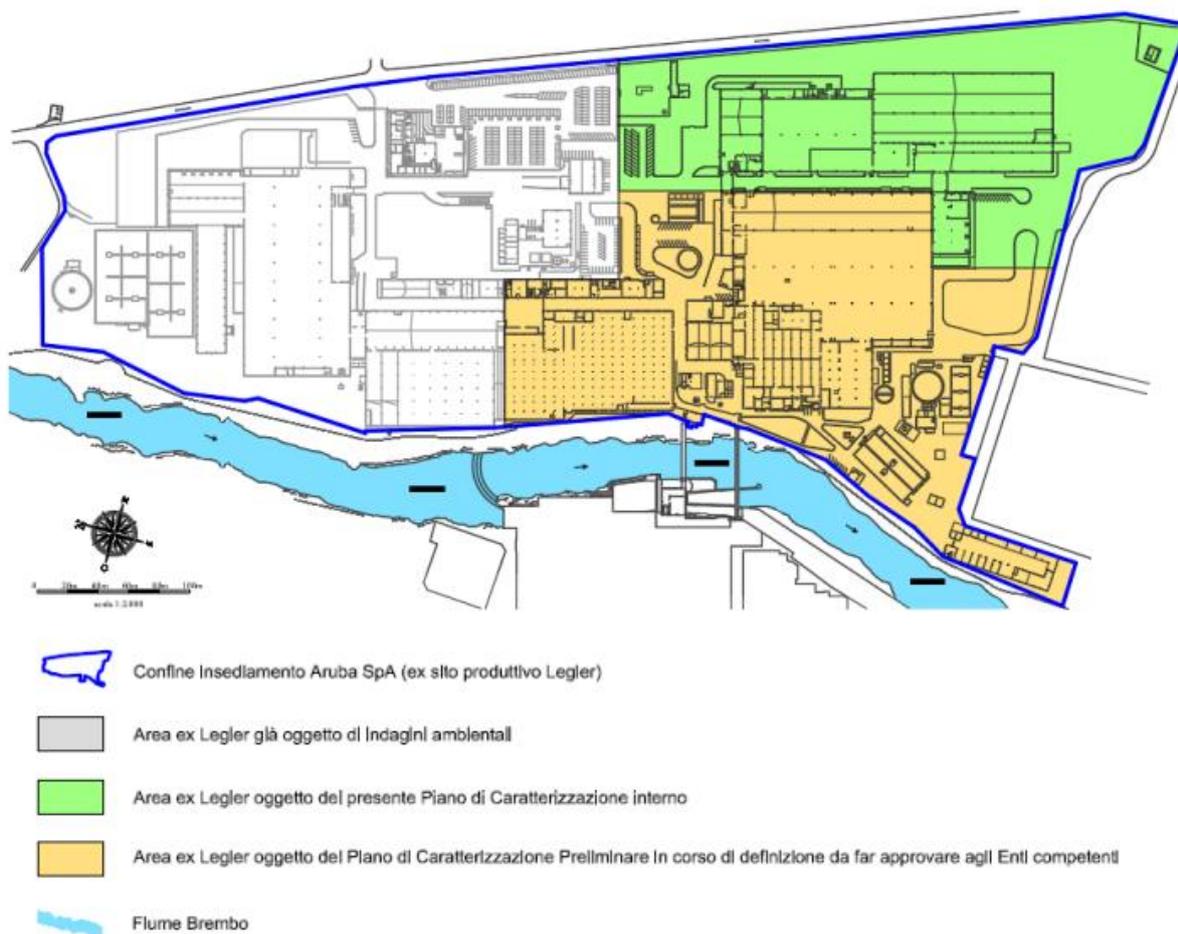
Stralcio planimetrico con individuata l'area oggetto di caratterizzazione ambientale interna – Relazione Tecnica
